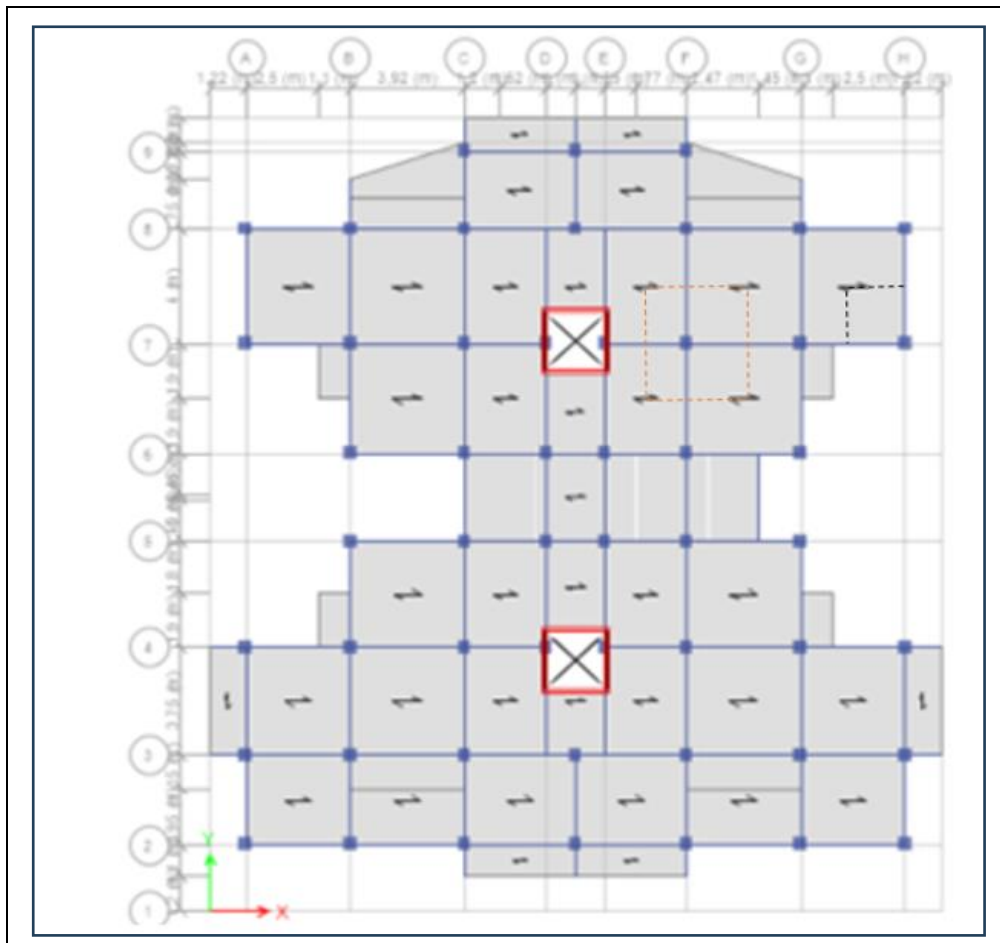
plan de repérage des poteaux les plus sollicités dans le plan.
